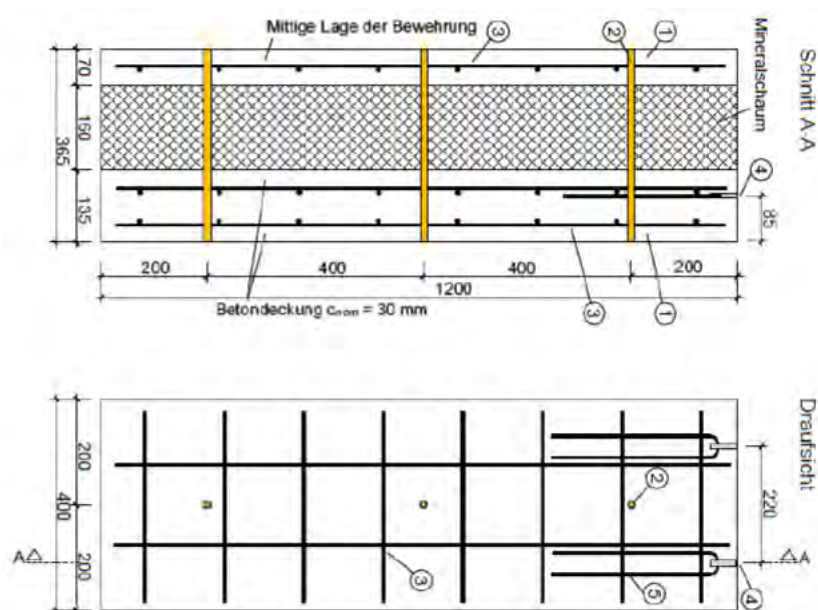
Sandwichelement im Querschnitt und Grundriss.
